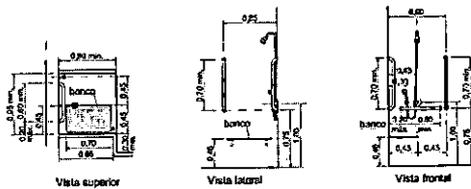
Boxe para chuveiro com barras vertical e horizontal — Exemplo
